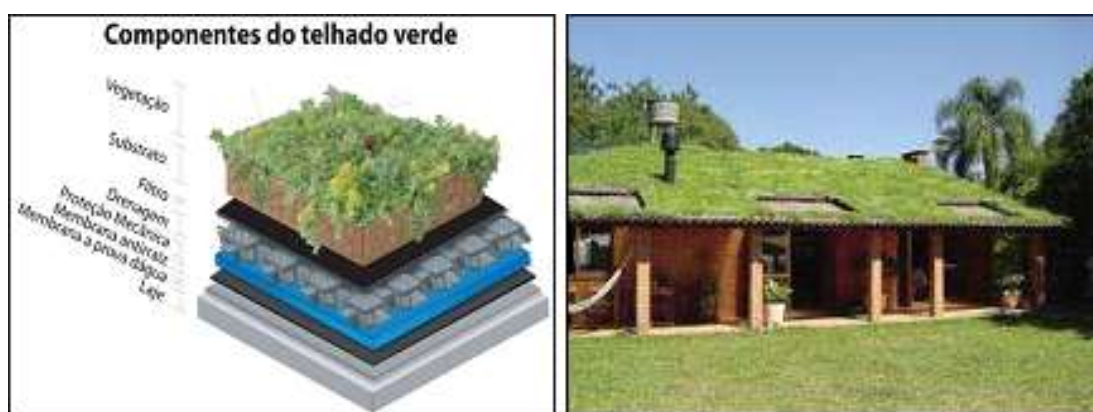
Esquema construtivo de telhado verde (Esquerda) e Telhado verde com plantas (Direita)
